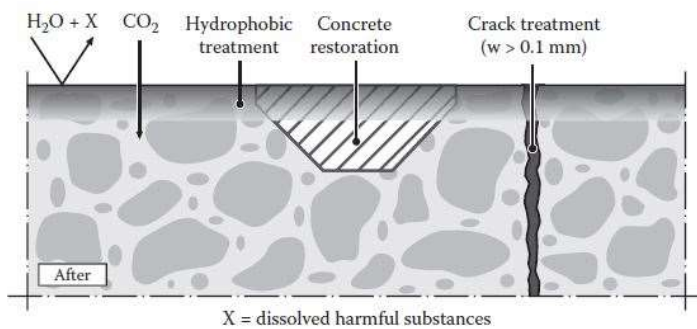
Exemplificação de correções típicas em estruturas de betão armado (RAUPACH, BUTTNER 2014).
